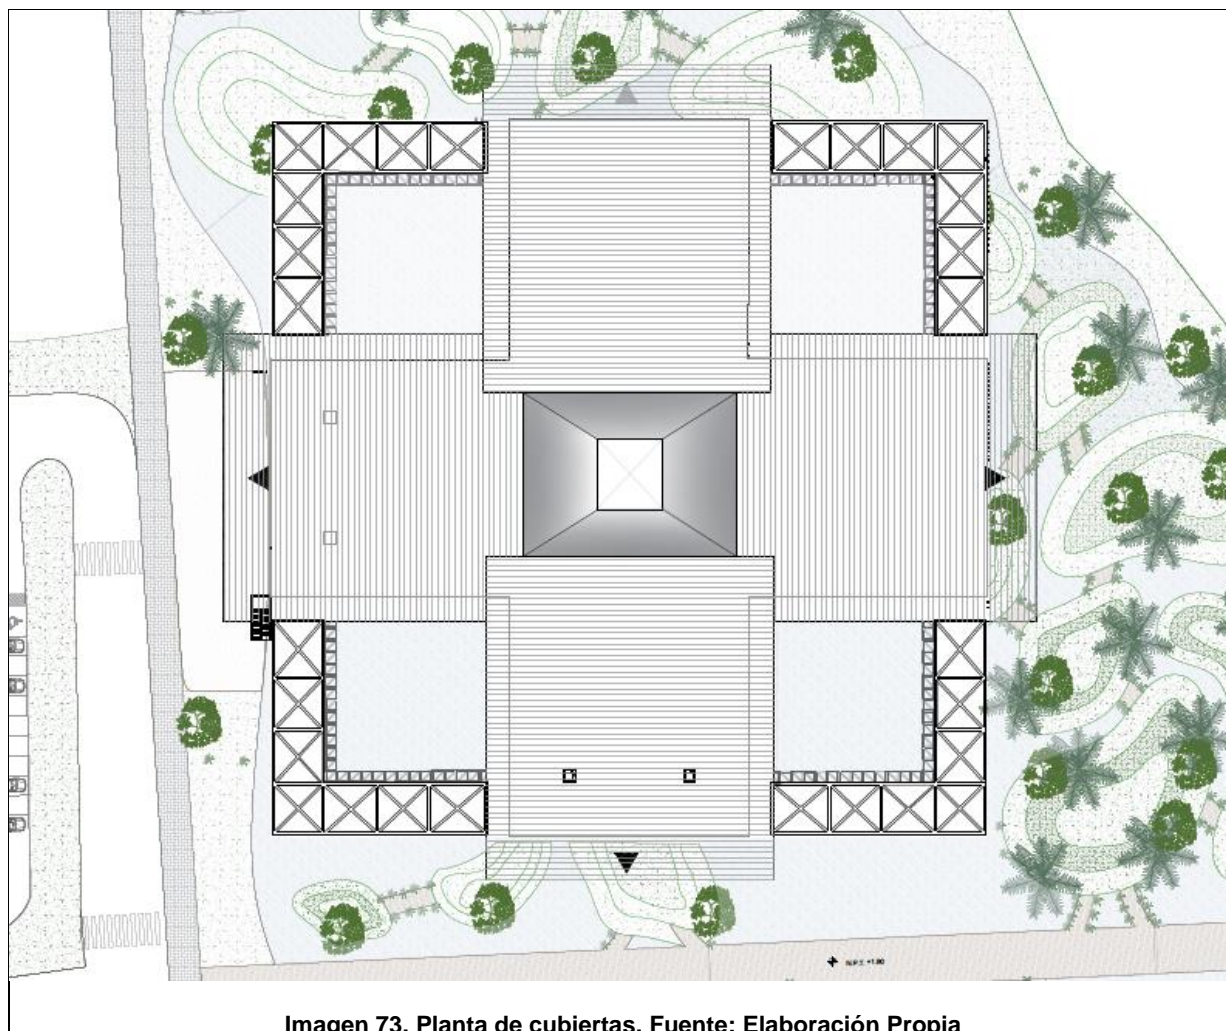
Planta de cubiertas. Fuente: Elaboración Propia
